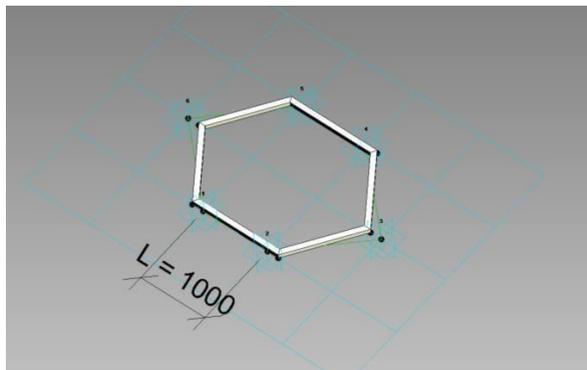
Primera familia creada. Montante exterior hexagonal Fuente: Imagen propia modelo en Revit
